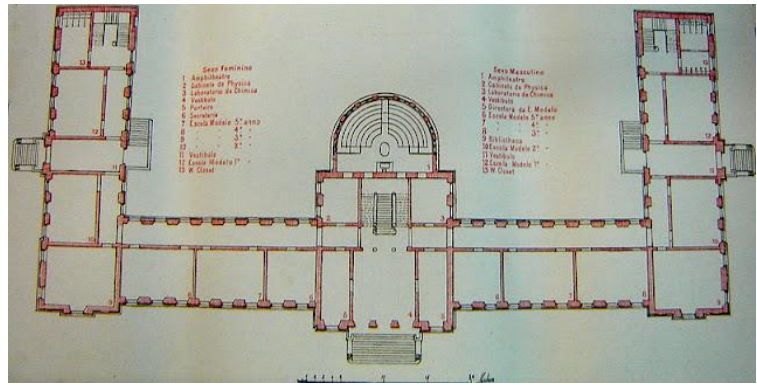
Planta baixa original da Escola Normal de São Paulo: seção feminina do lado esquerdo e masculina do direito. Fonte: IECC(online)
